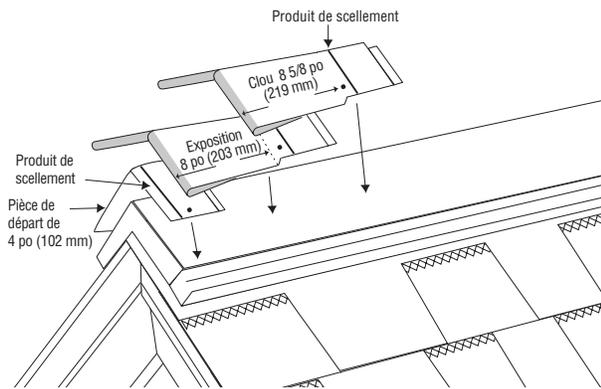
Recouvrement d'arête et de faîte avec Mountain Ridge.
